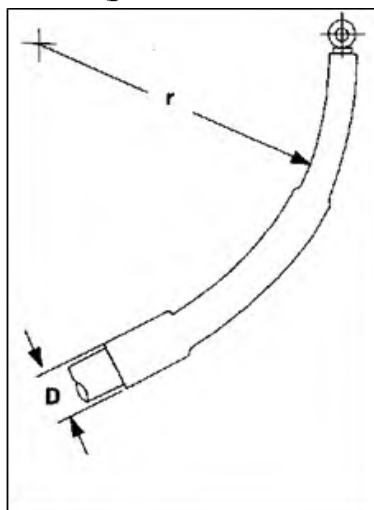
Изгиб кабеля при подсоединении жил к оборудованию.
